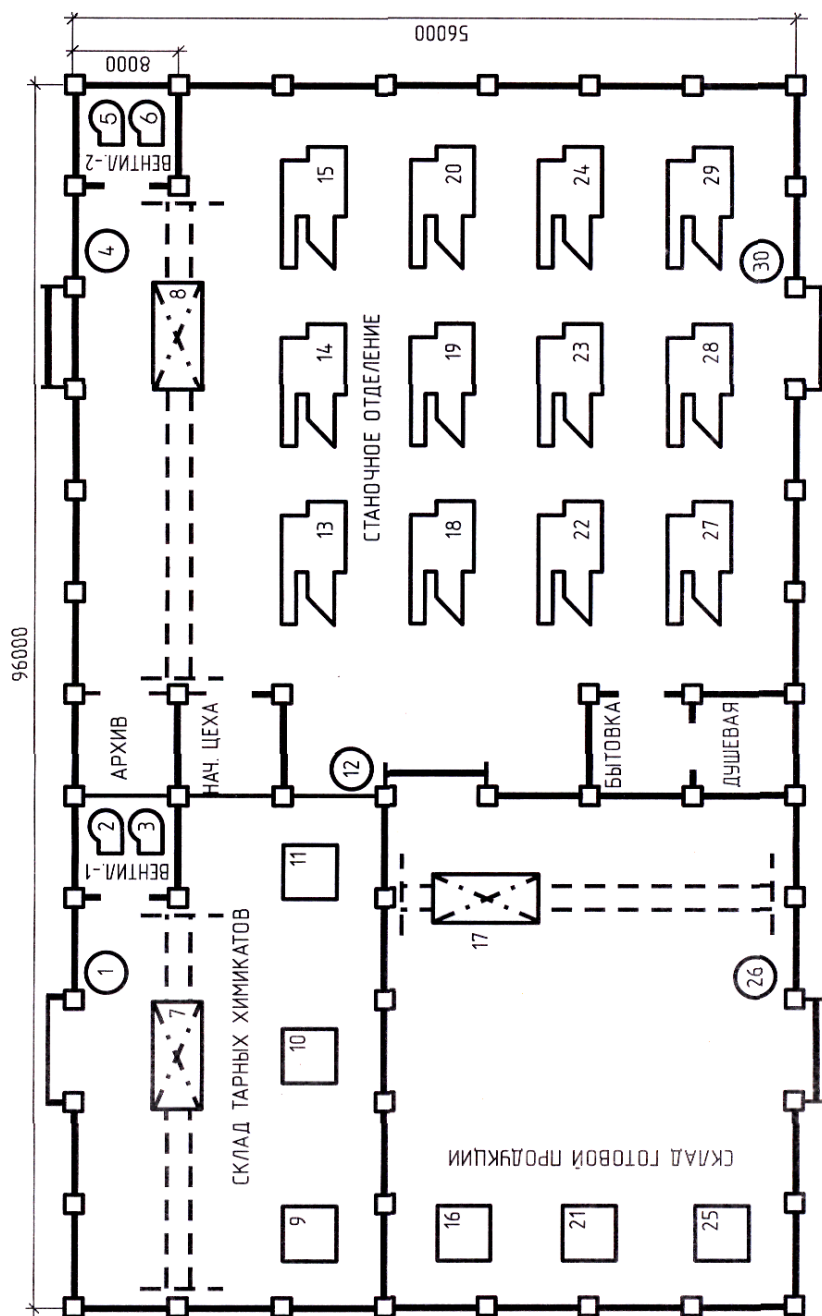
План расположения ЭО шлифовального цеха
